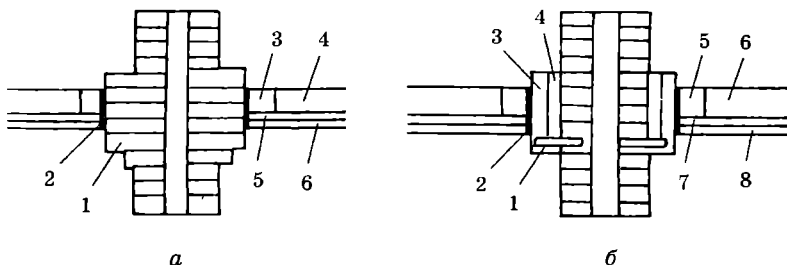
Устройство горизонтальной противопожарной разделки у дымовой трубы в уровне чердачного или междуэтажного перекрытия:
